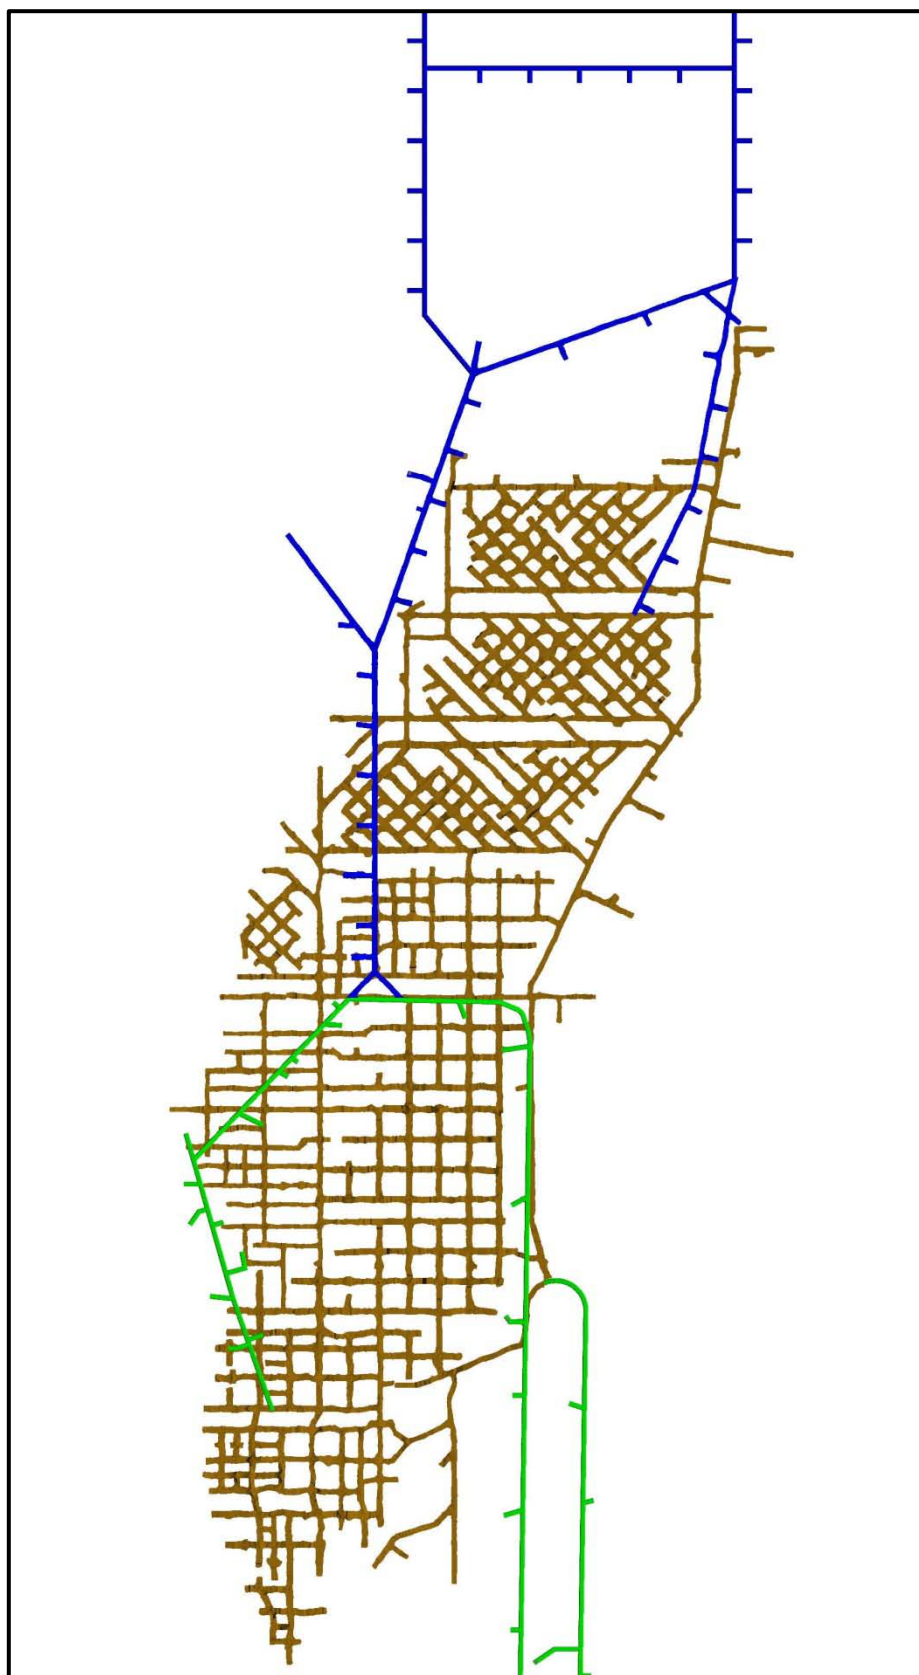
Vista en planta de extracción desarrollada en Longacho.
